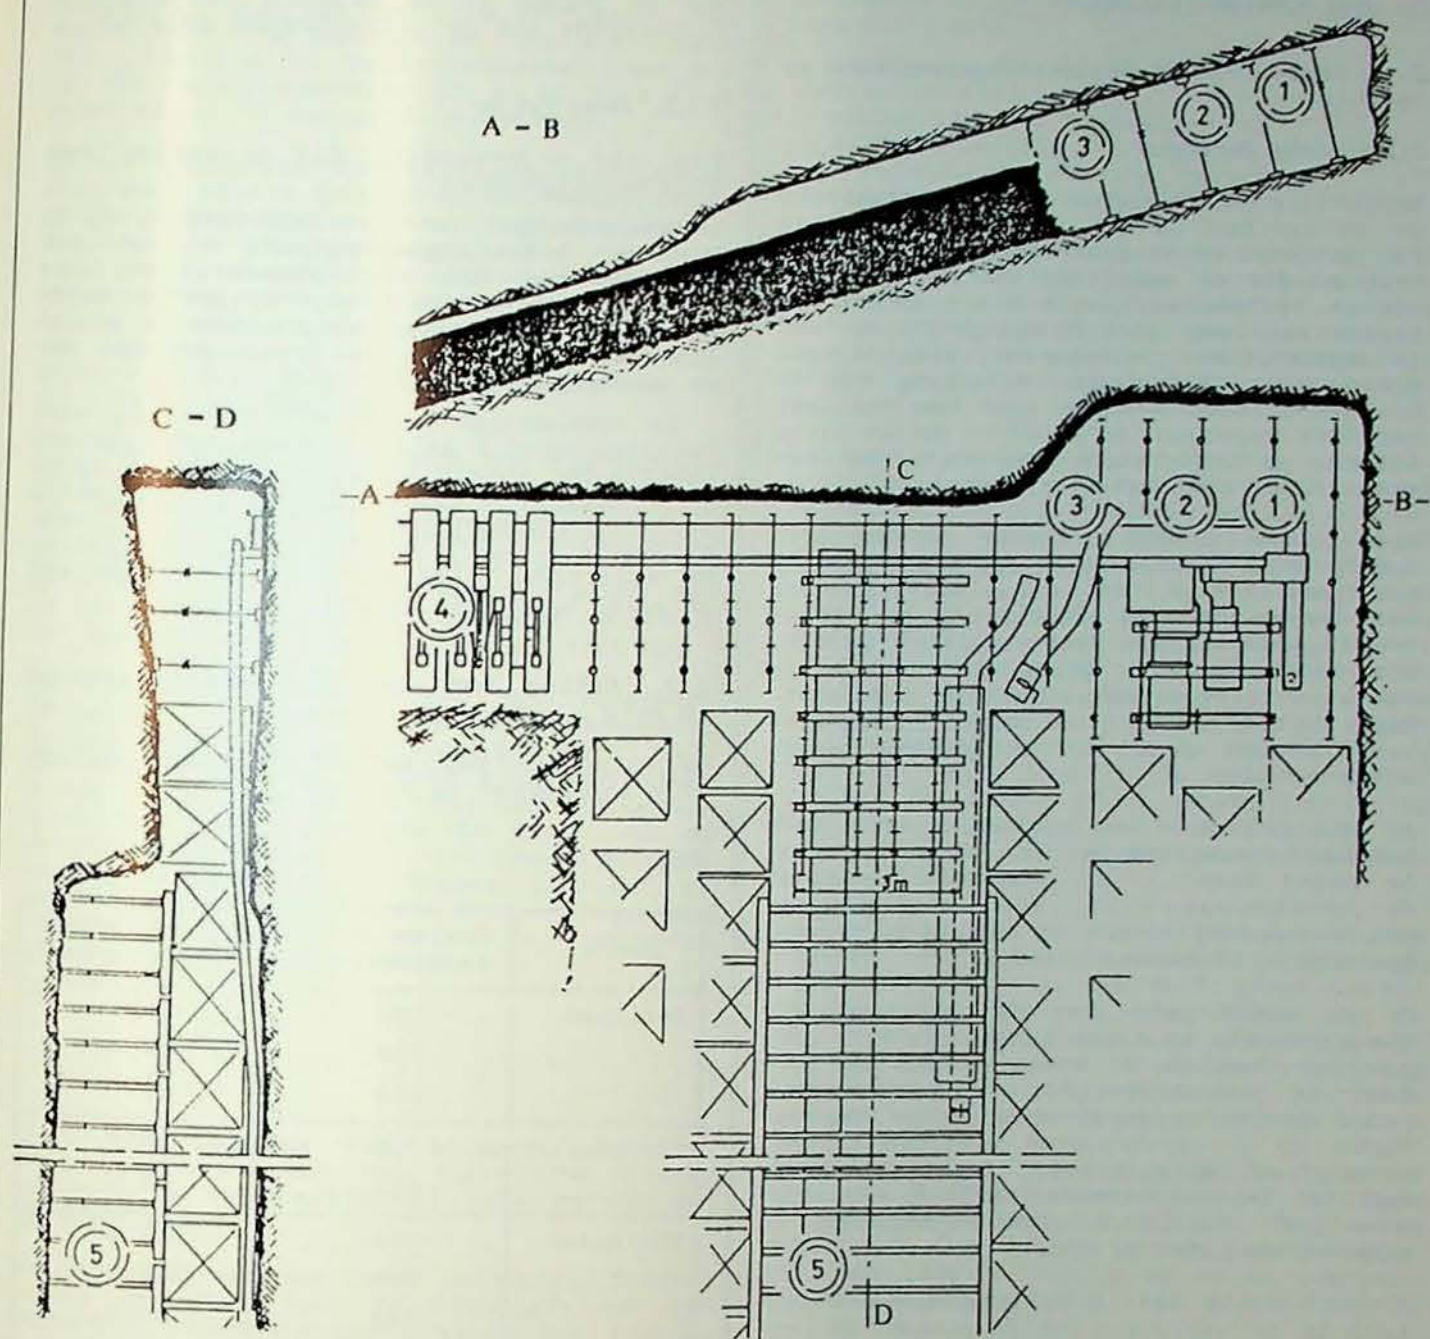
Bovenzicht en doorsneden van het bovenste pijlerruiteinde
